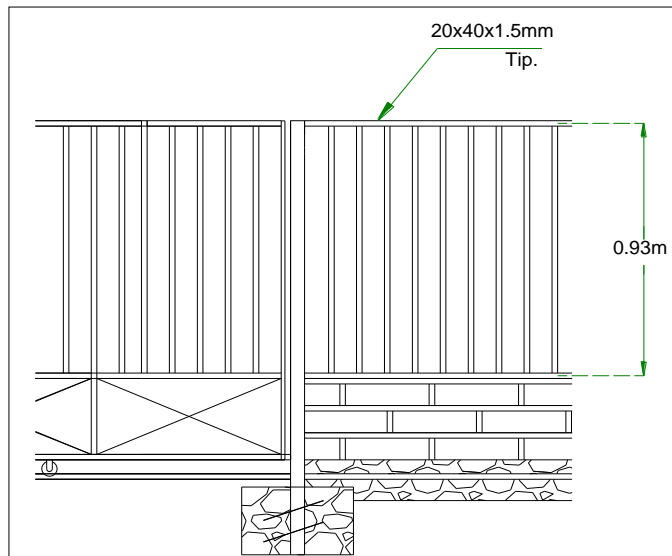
Detalles Medida de Perfiles Horizontales a Eje Fuente: Propia
